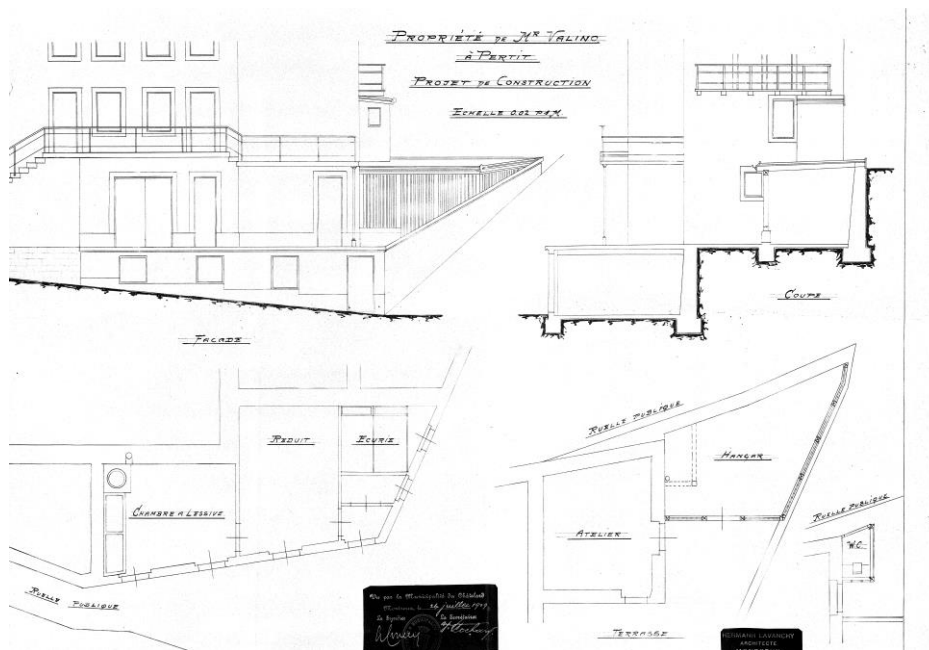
Plans de l'architecte Hermann Lavanchy, acceptés le 26 juillet 1909
